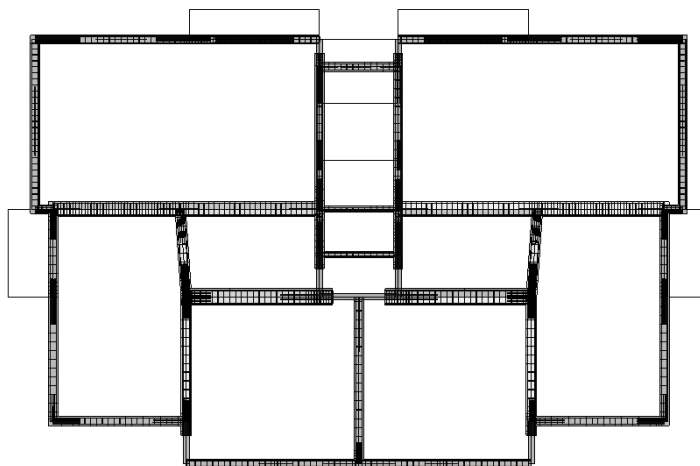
Vista em planta dos modelos de armaduras em vigas
